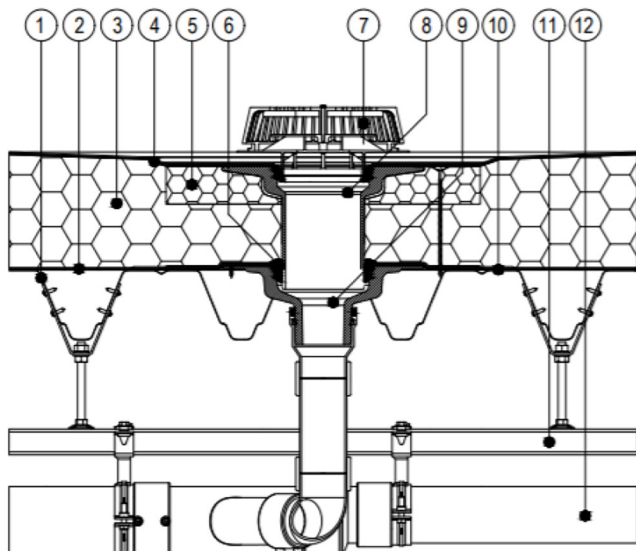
Вакуумная воронка SitaDSS Profi с соединительным фартуком, с надставным элементом SitaDSS Profi с соединительным фартуком, с элементом Airstop и листвоуловителем: 1 – несущая конструкция; 2 – пароизоляция; 3 – теплоизоляция; 4 – гидроизоляция; 5 – изоляционная плита SitaDSS Profi для надставного элемента; 6 – уплотнительный манжет надставного элемента SitaDSS Profi; 7 – Airstop с листвоуловителем; 8 – надставной элемент SitaDSS Profi с соединительным фартуком; 9 – вакуумная воронка SitaDSS Profi с соединительным фартуком; 10 – усилительная пластина SitaMore; 11 – система крепления труб SitaDSS PE; 12 – система труб SitaDSS PE [3]
